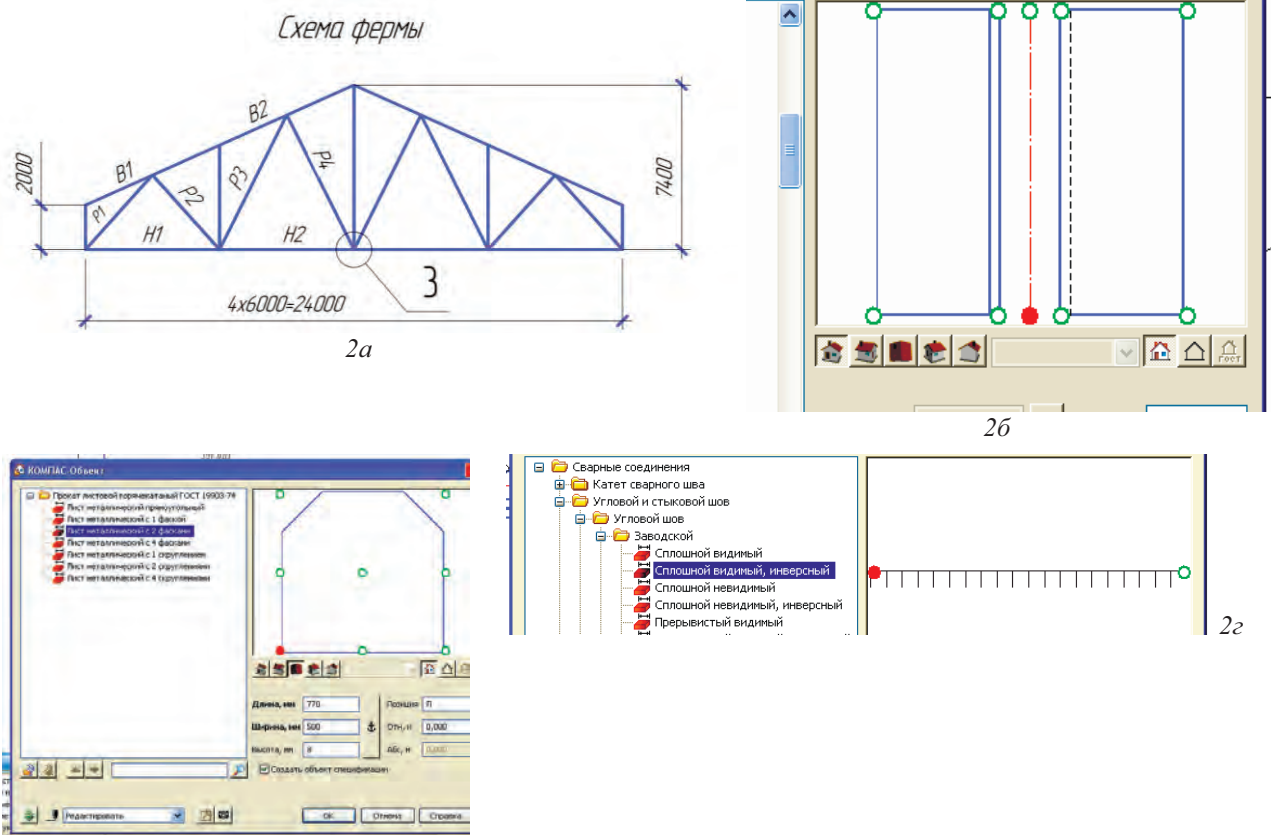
Использование библиотеки «Металлоконструкции» для выполнения чертежа узла металлоконструкции
